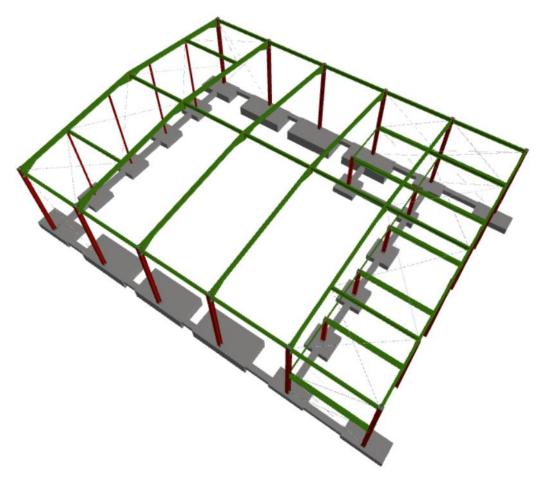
Zapatas nave. Fuente; CYPE 2019
